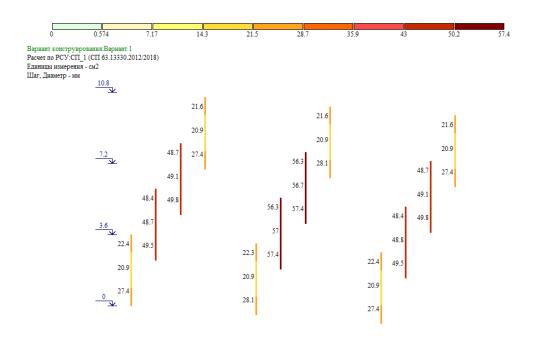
Требуемое армирование колонн 1-го этажа, до усиления
